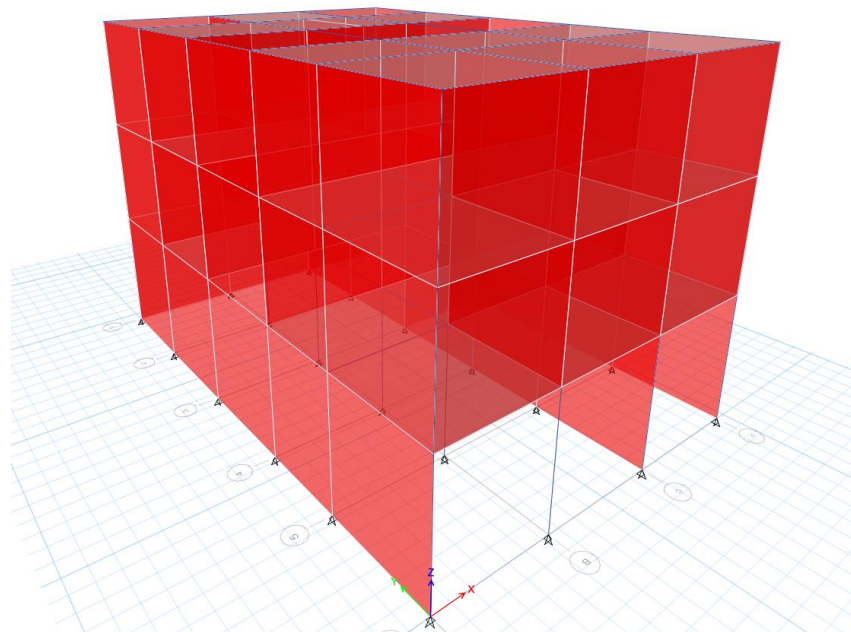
Modelado de elementos placa, vigas y columnas, Elaboración propia, ETABS v19, 2023.
